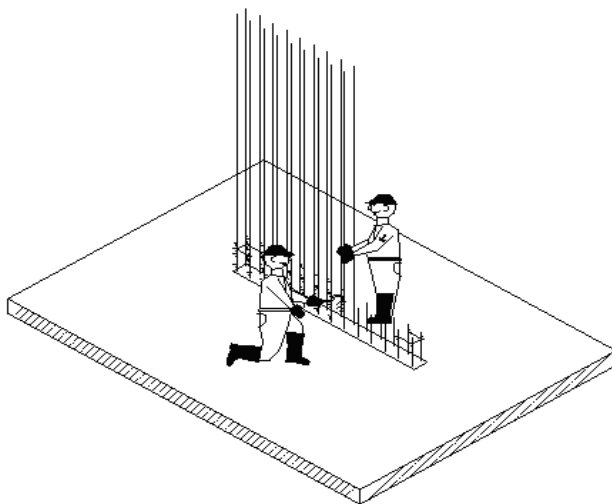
Вязка вертикальных отдельных арматурных стержней
